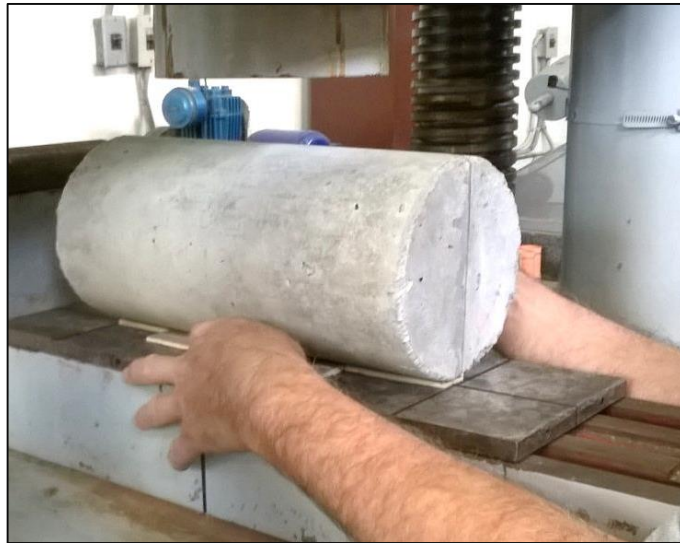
Colocado de tablilla, platina inferior y probeta en la maquina uniaxial
